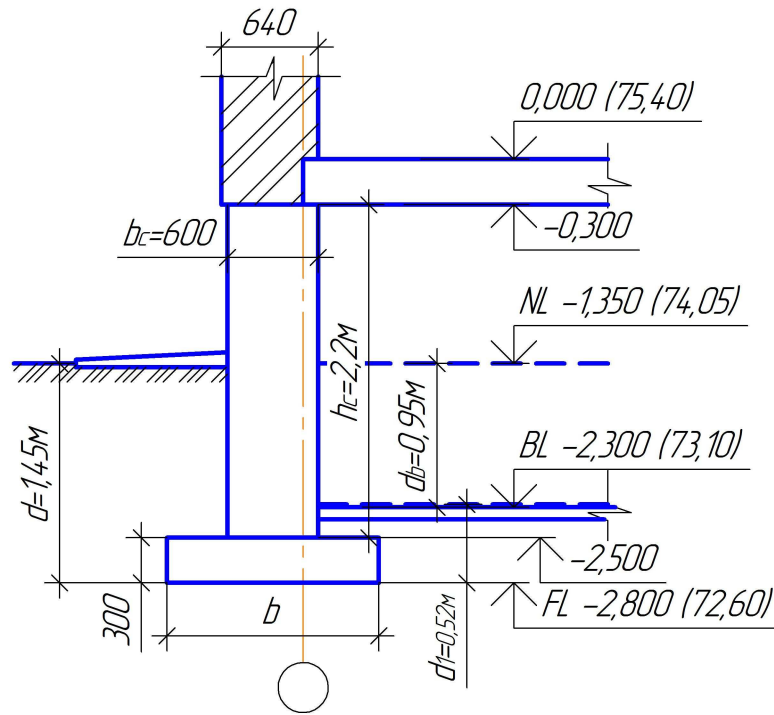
Расчетная схема к определению ширины подошвы фундамента
